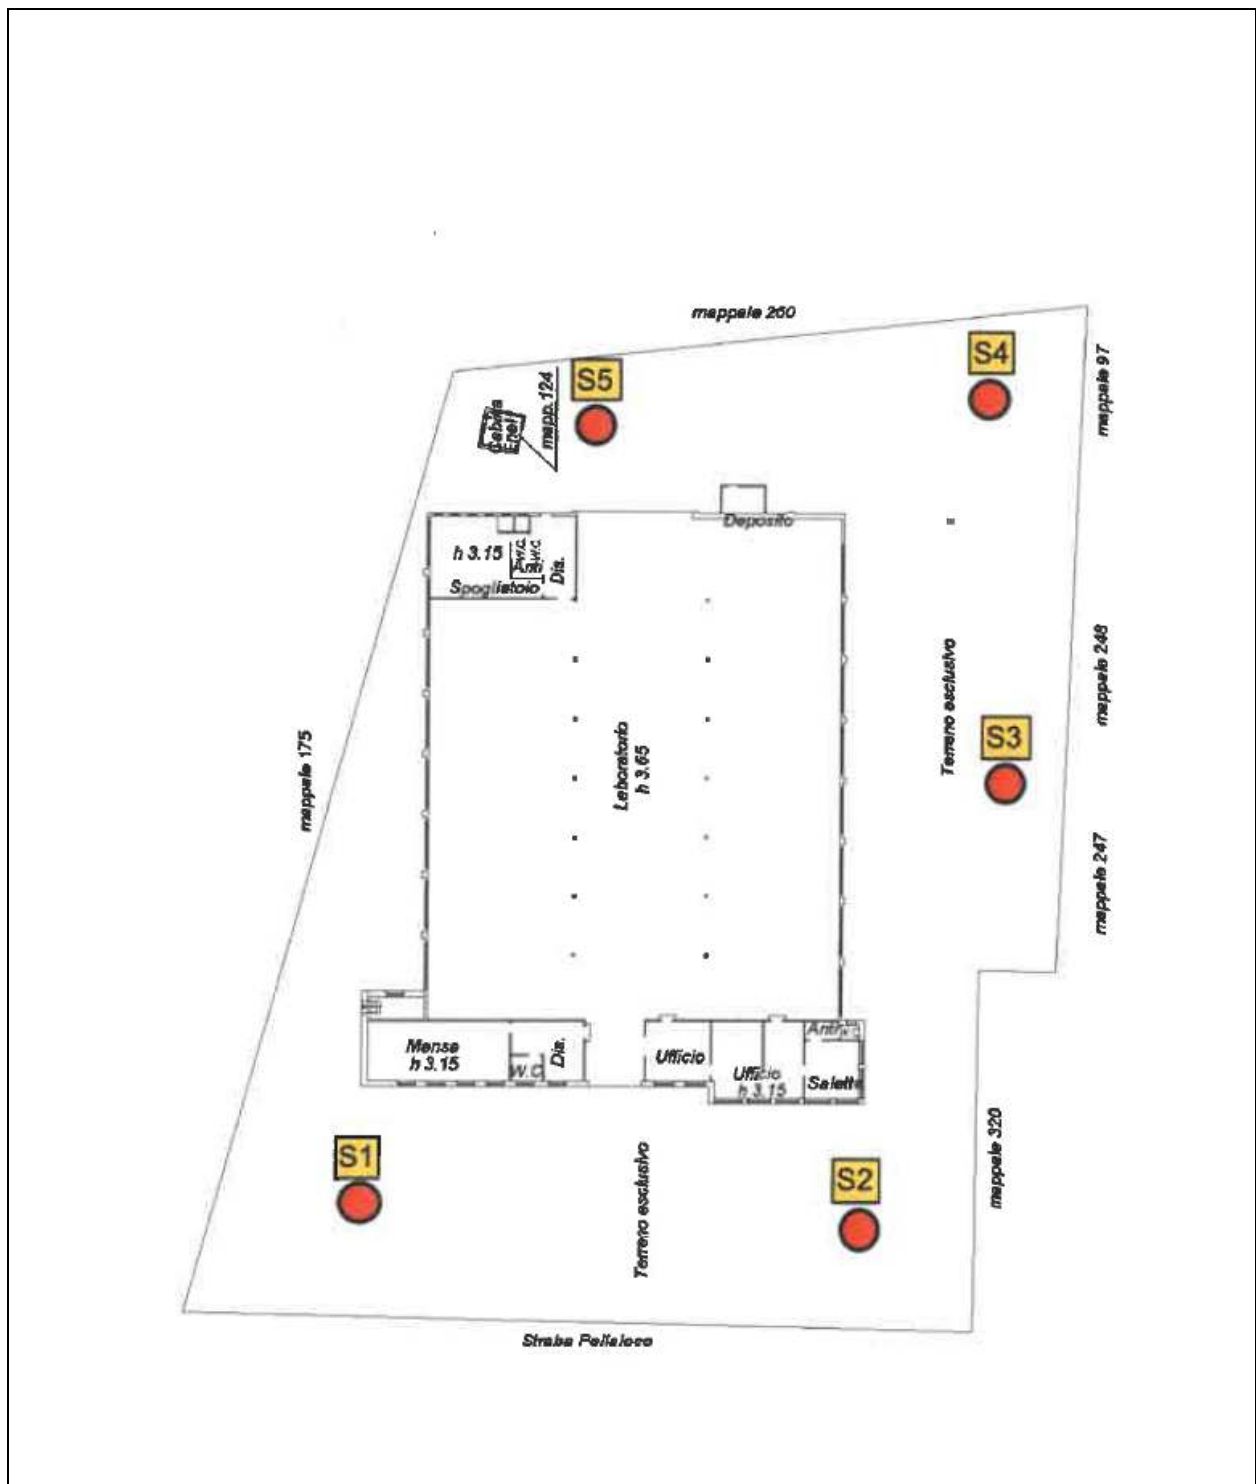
Planimetria con ubicazione dei punti di campionamento.
